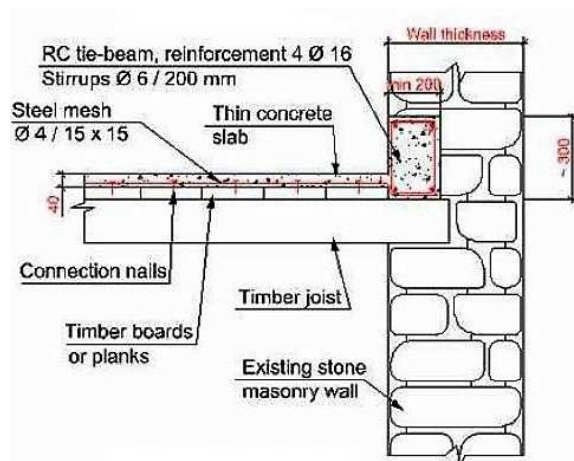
Reforço com lâminas e vigas de betão.[20]
